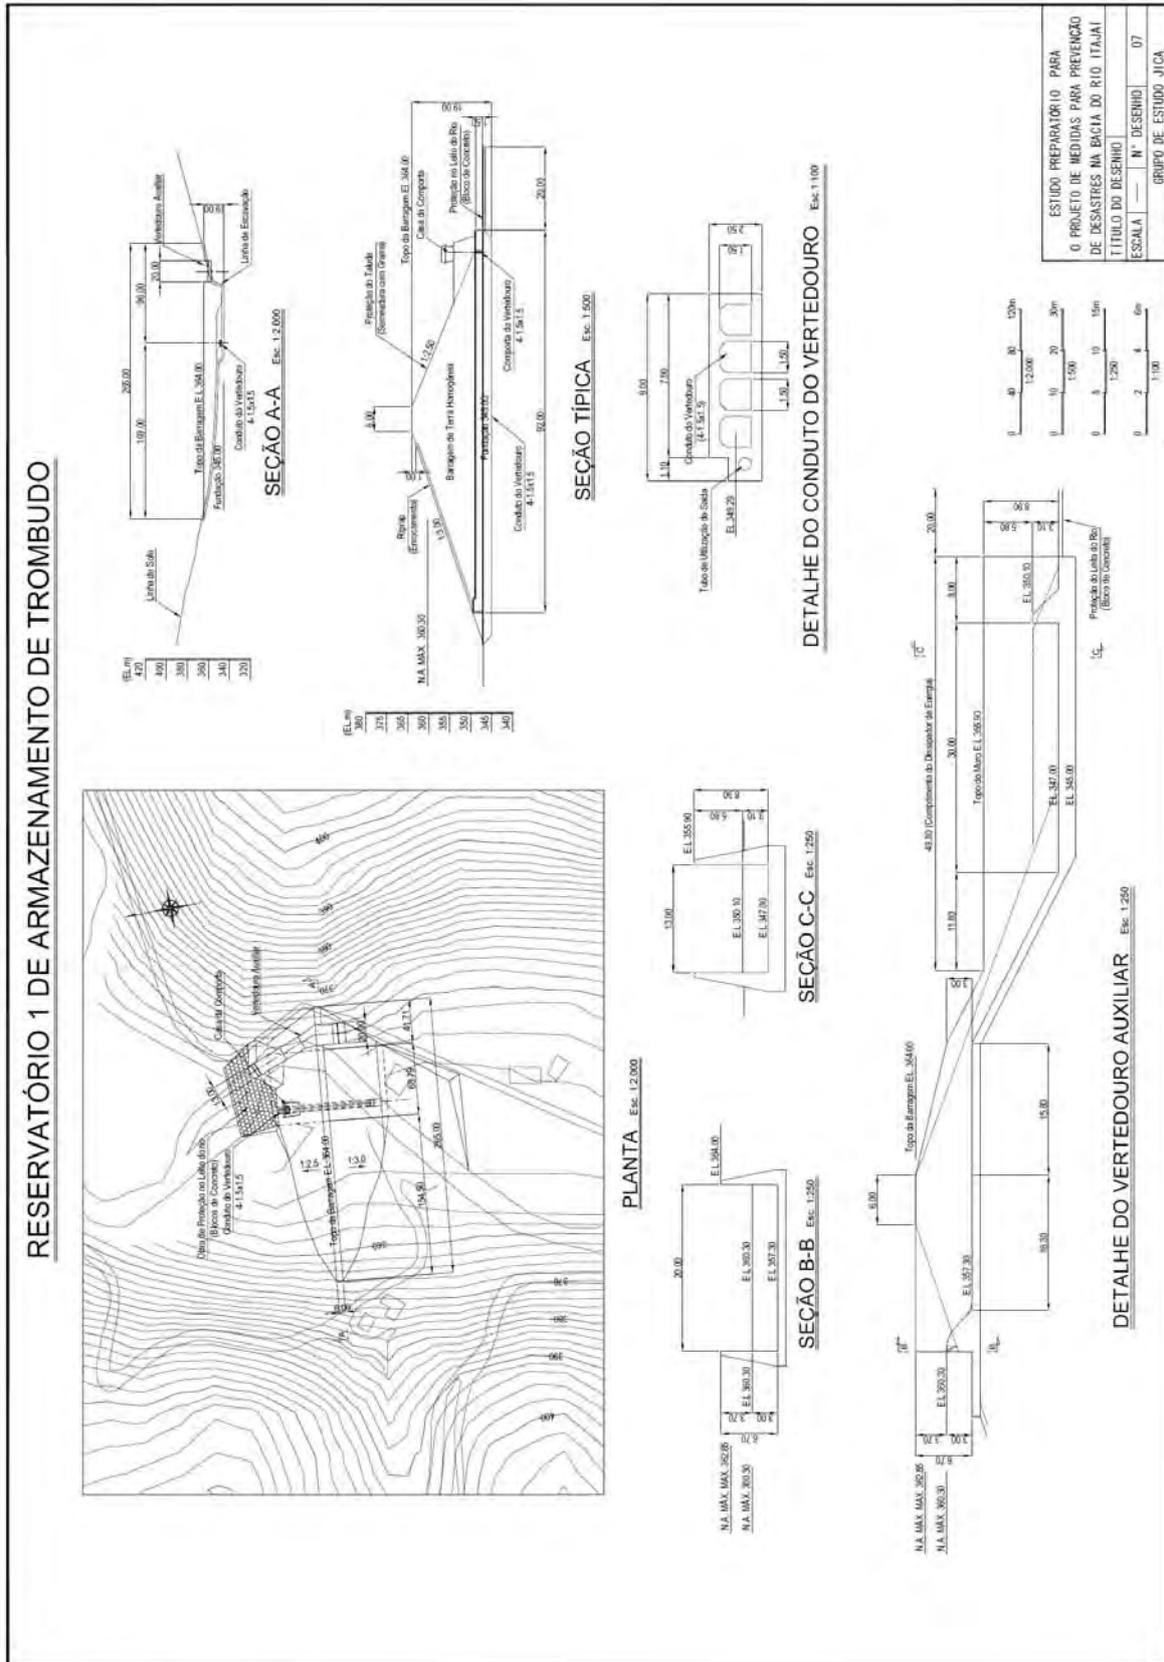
Projeto estrutural da barragem de pequeno porte – Trombudo 1 (reservatório de retenção)
